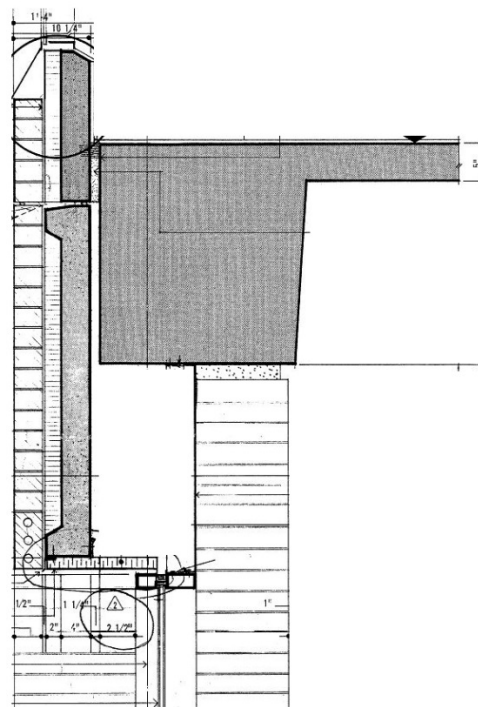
Coupe illustrant la construction du panneau de guidage pour le vitrage au rez-de-chaussée.
